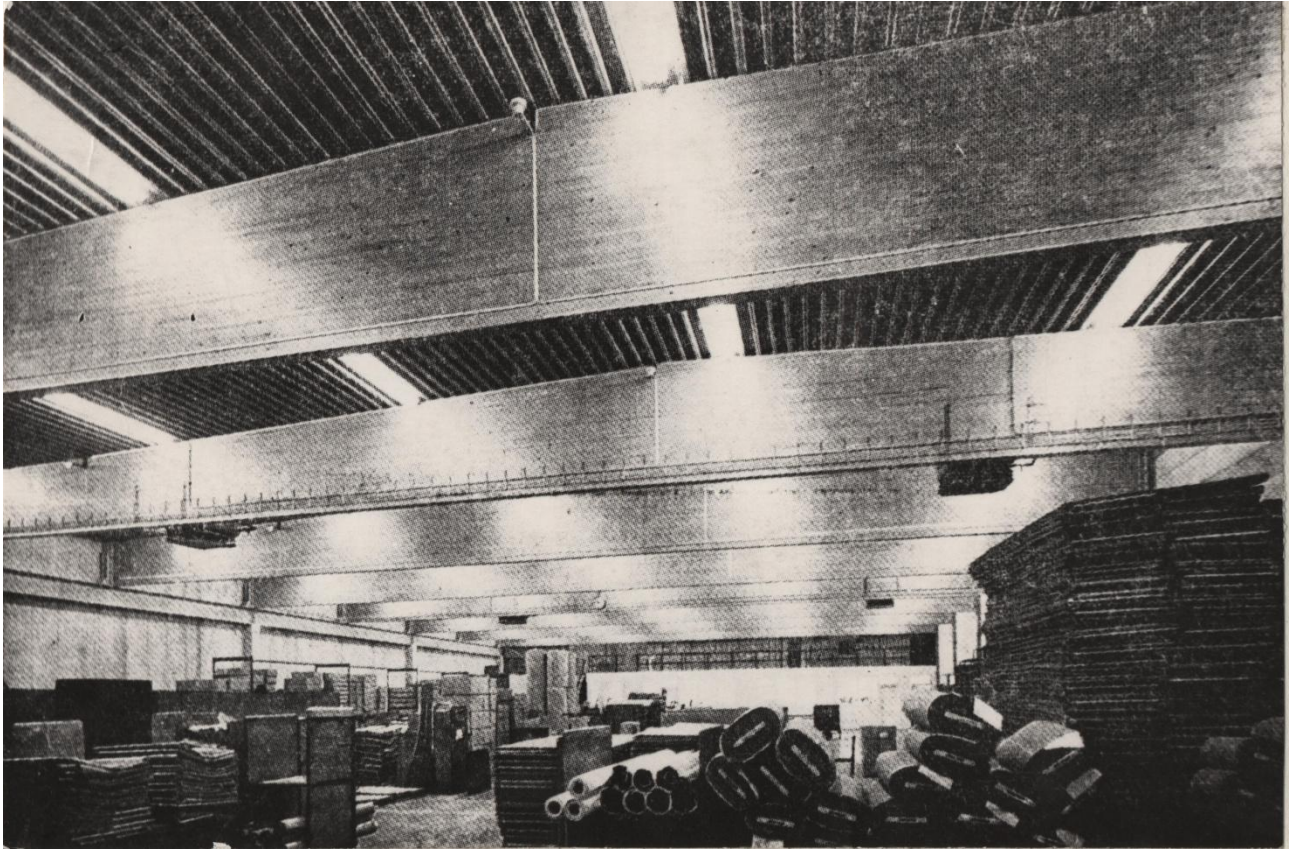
Складское помещение. Армированные балки пролетом 30,0 м
